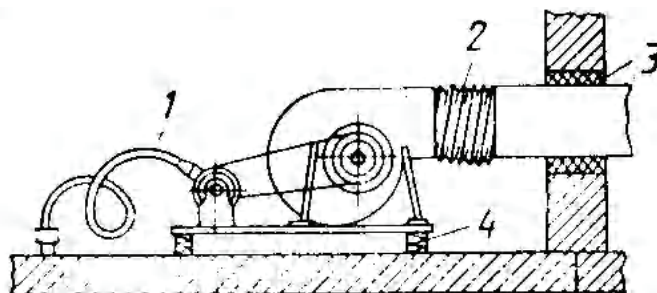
Схема виброизоляции вентиляционных установок:
